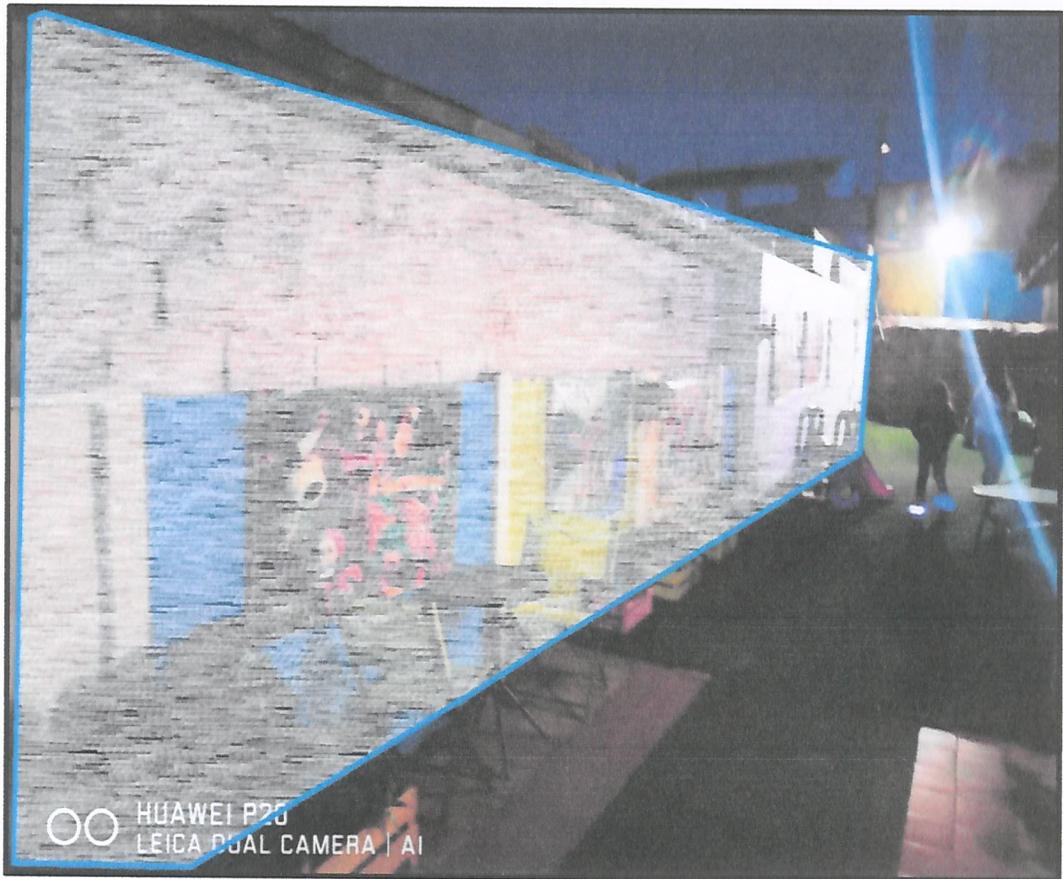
“Sección de Plano donde indica Área de Nueva Barrera”
